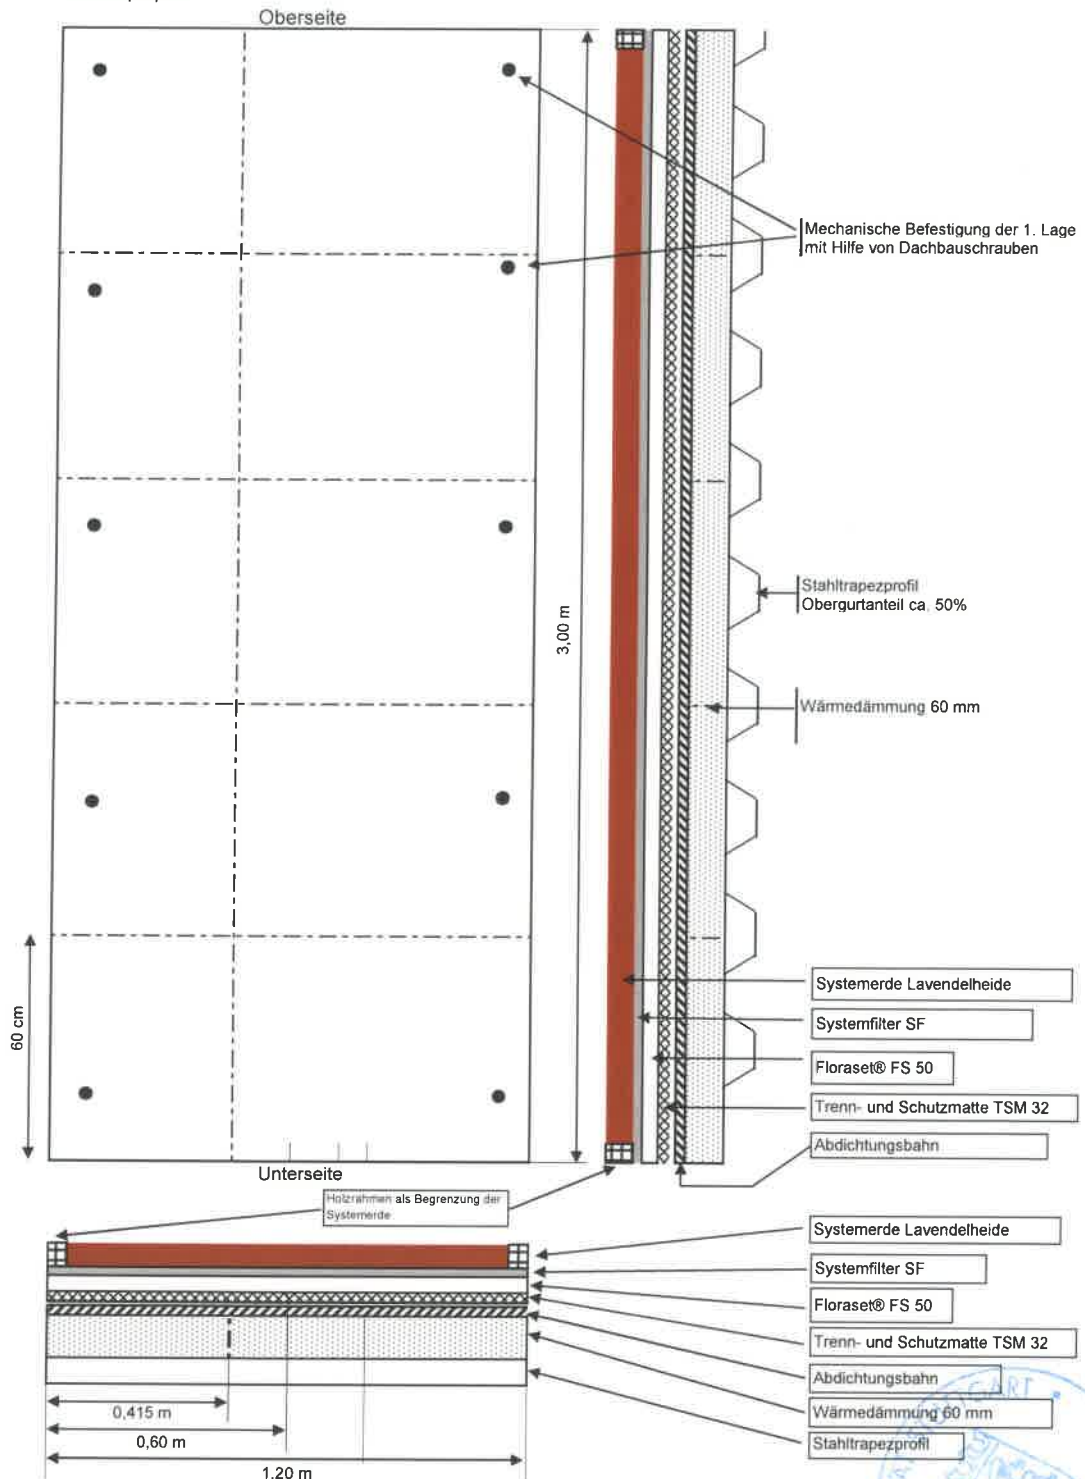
Grundriss und Querschnitt des Aufbaus V2
